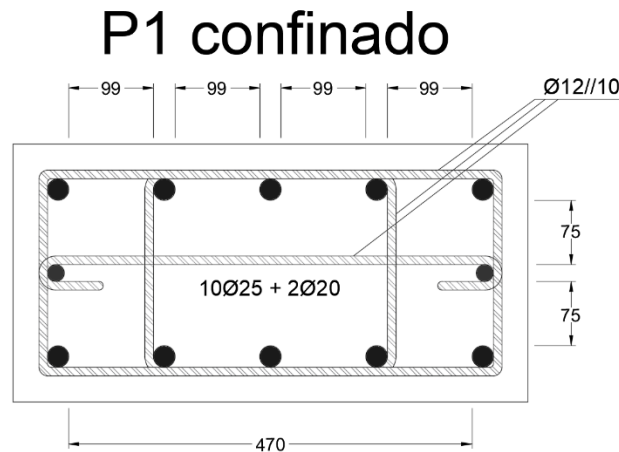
Armadura longitudinal e transversal do P1 confinado para zonas críticas.
